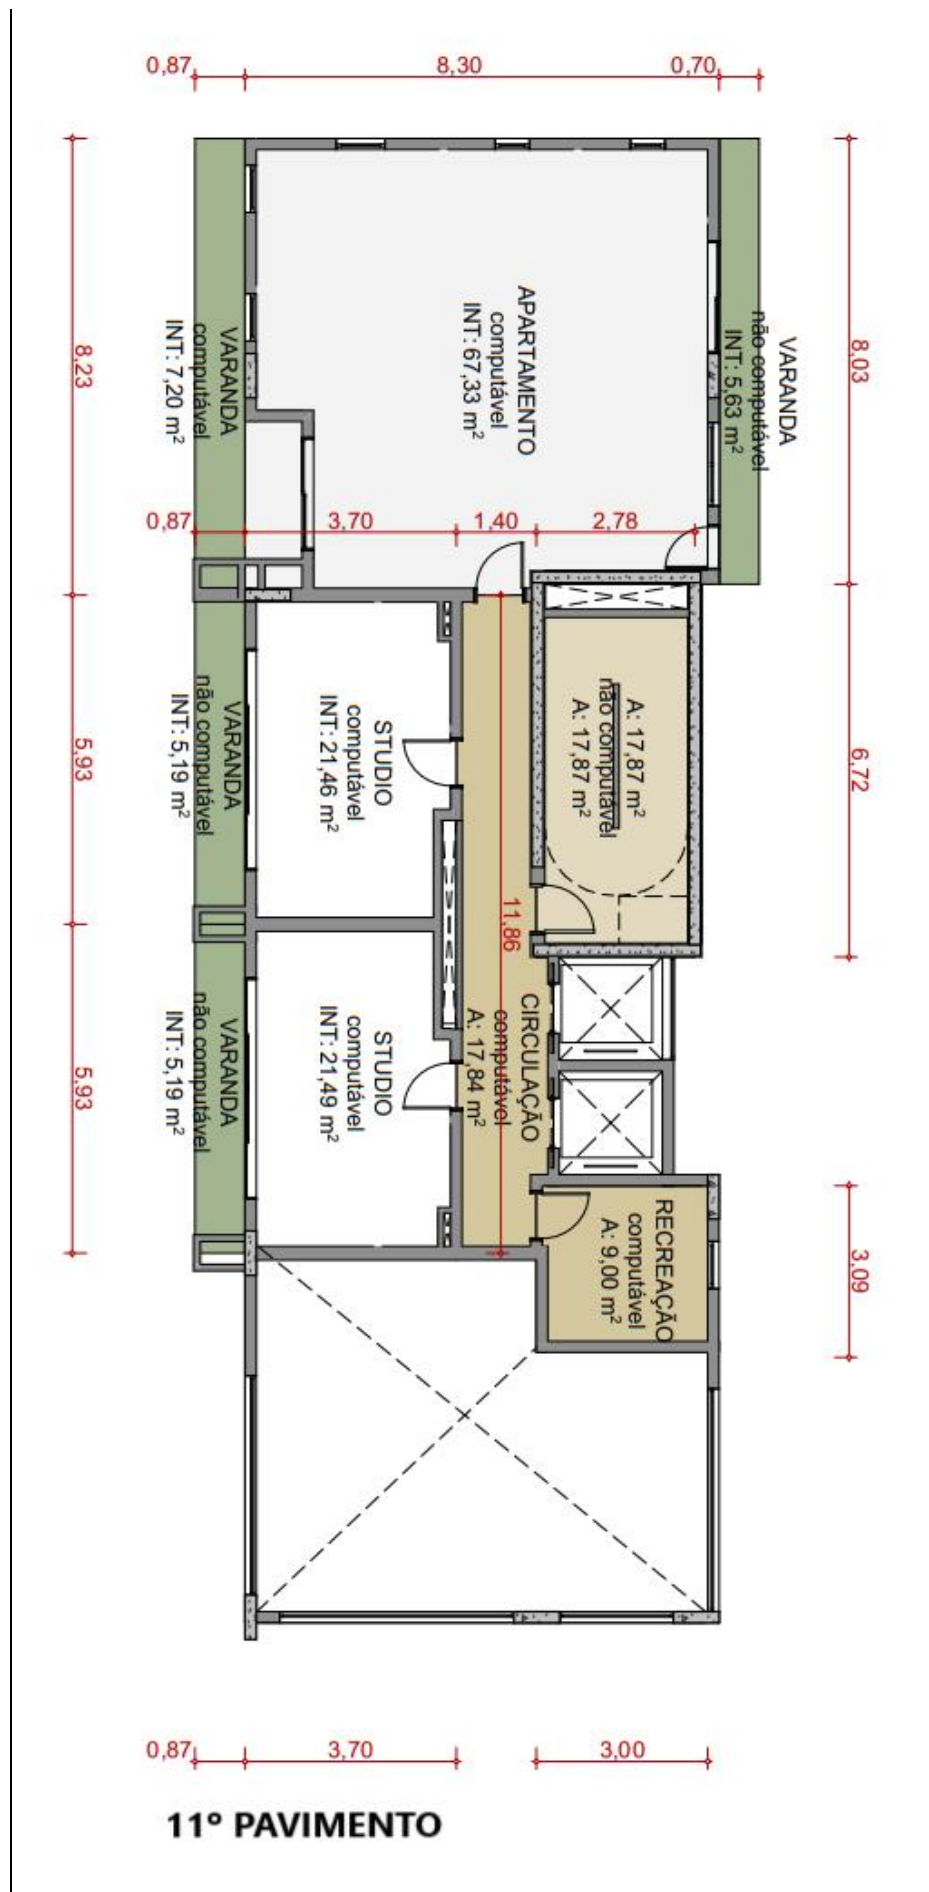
Planta 11º Pavimento do Condomínio Sintropia Sky Garden.
